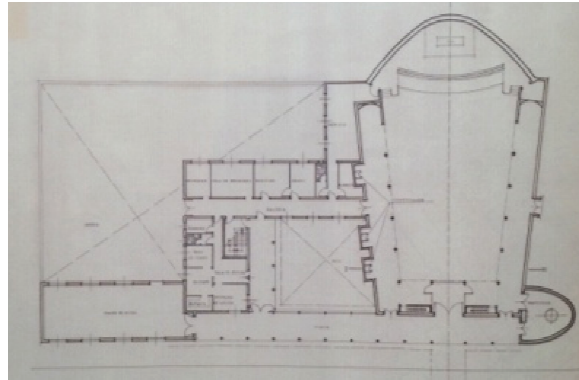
Planimetría de la Iglesia de Santa María de las Flores y San Eugenio.
